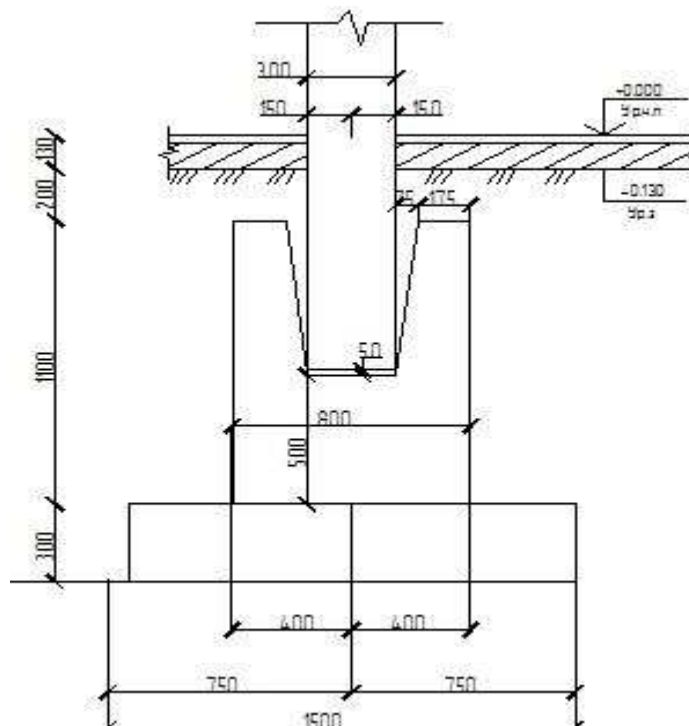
Конструктивная схема фундамента Ф1
